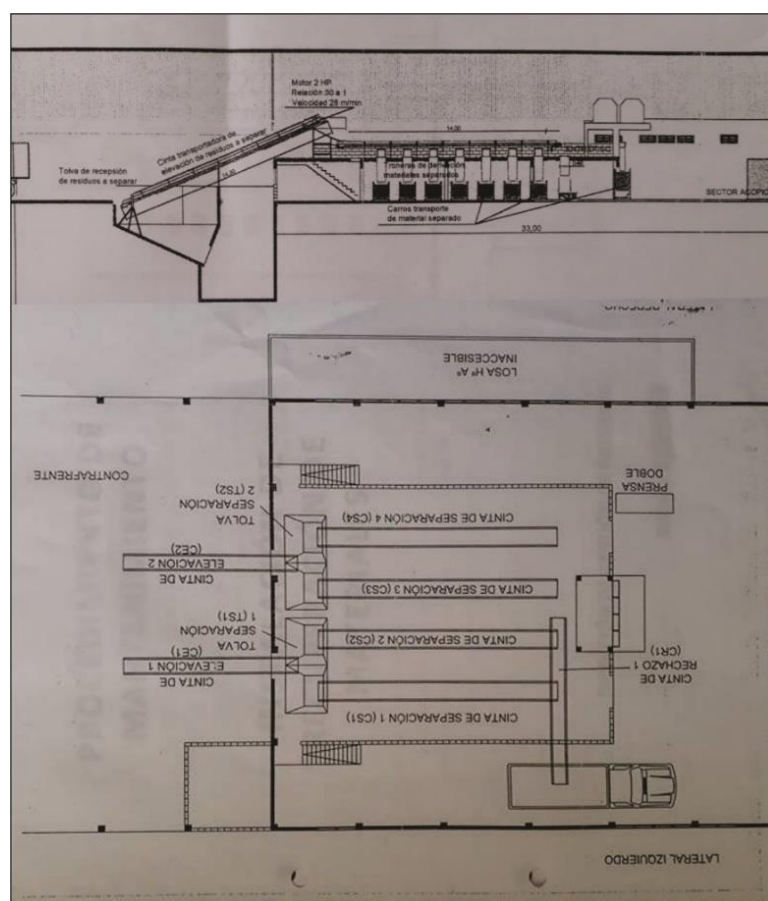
Planos de la Planta Modelo de Separación del proyecto ECO-DES.
